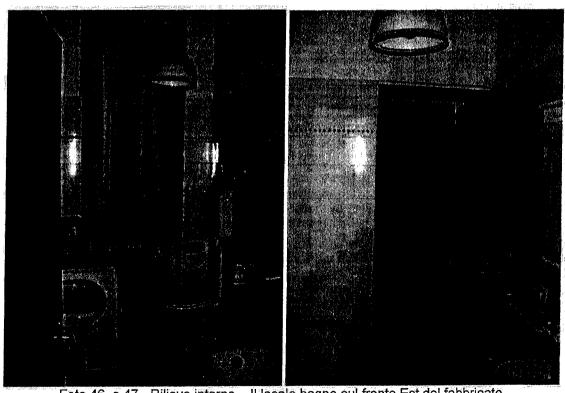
e 47 - Rilievo interno – Il locale bagno sul fronte Est del fabbricato.
